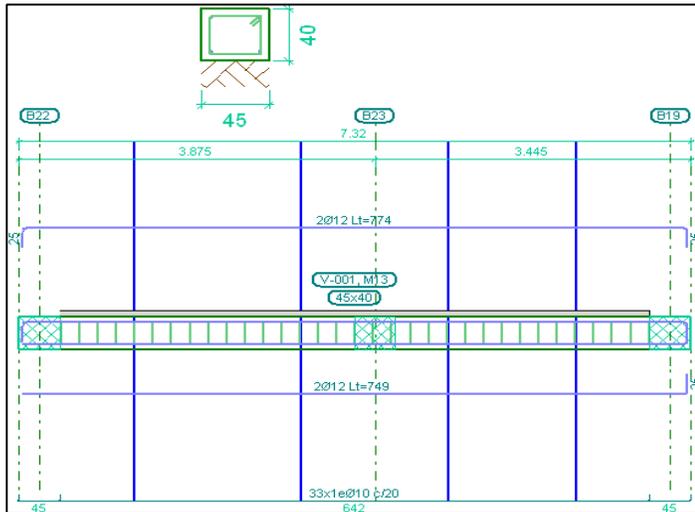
Forma de transmisión de esfuerzos vigas de cimentación
